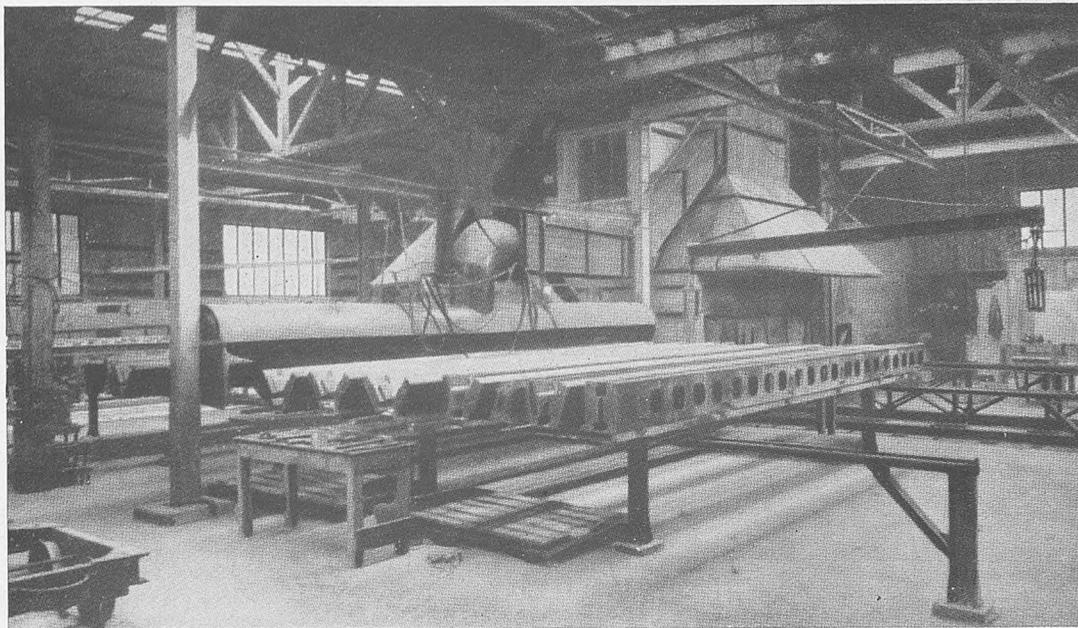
Moldes metálicos para la fabricación de viguetas pretensadas en una factoría francesa.
